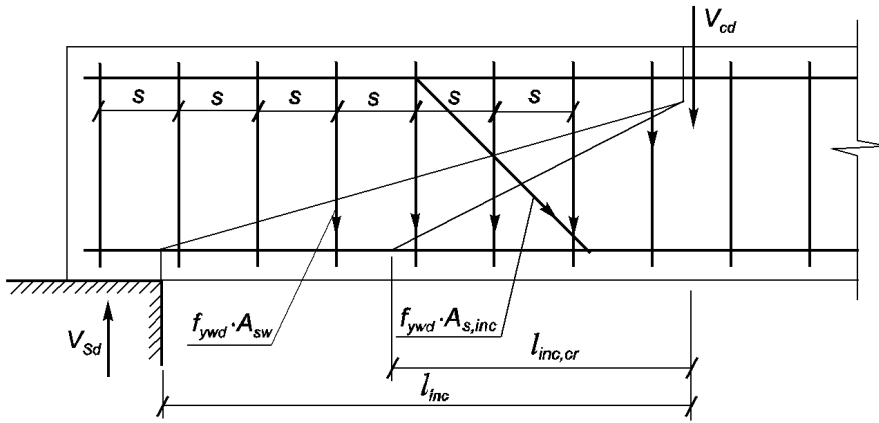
Схема усилий в сечении, наклонном к продольной оси железобетонного элемента, при расчете его по прочности на действие поперечной силы
